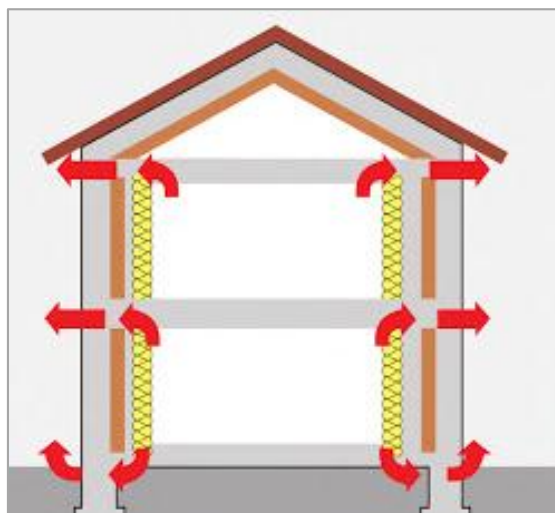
Exemple des ponts thermiques à travers l'enveloppe du bâtiment.
